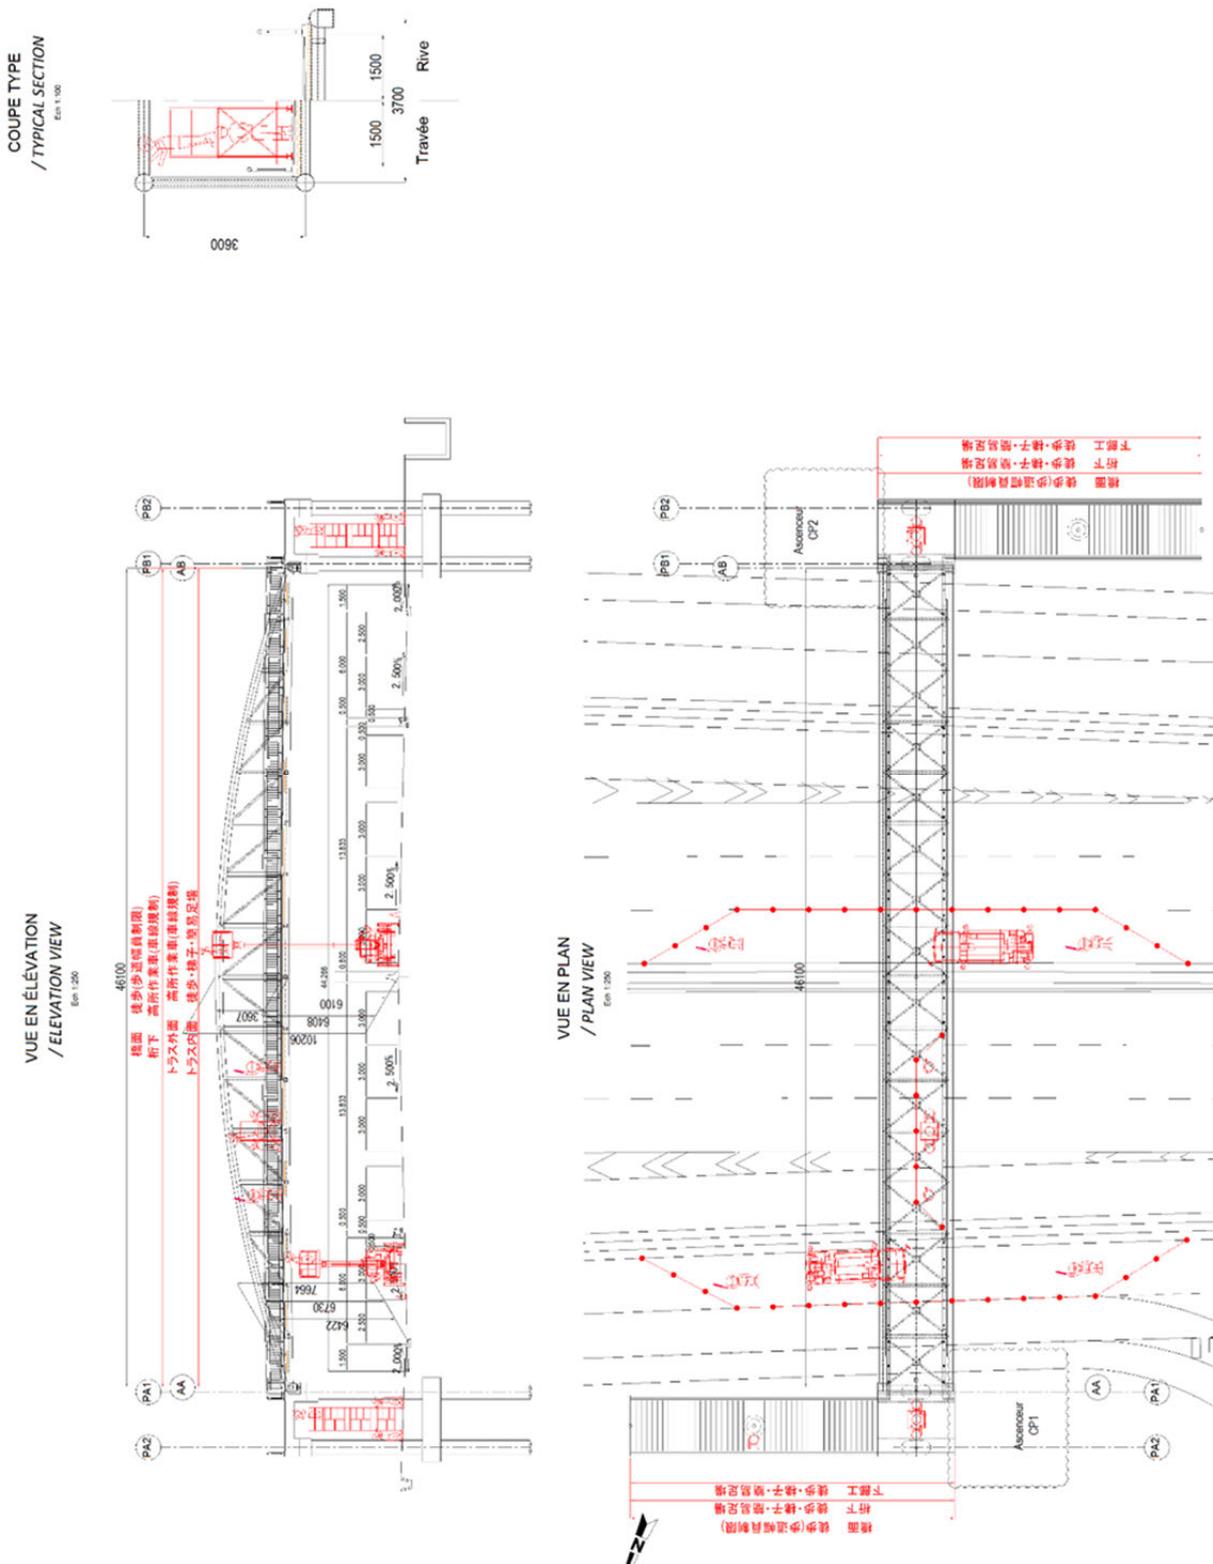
Inspection à l'aide d'un échafaudage simple
